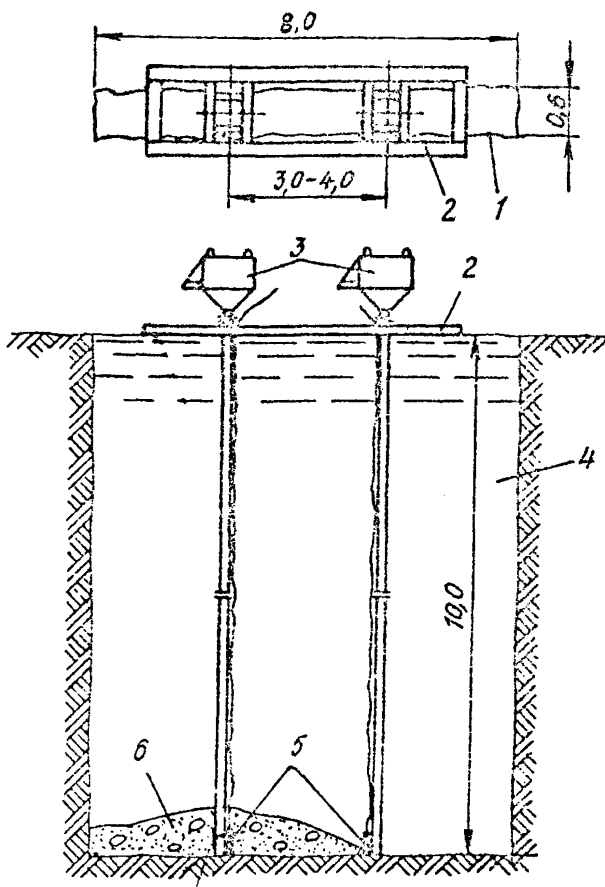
Схема бетонирования захватки длиной 8 м двумя бетонными трубами: 1-траншея; 2-кондуктор; 3-бетонные трубы; 4-глинистый раствор; 5-вибраторы; 6-бетон
